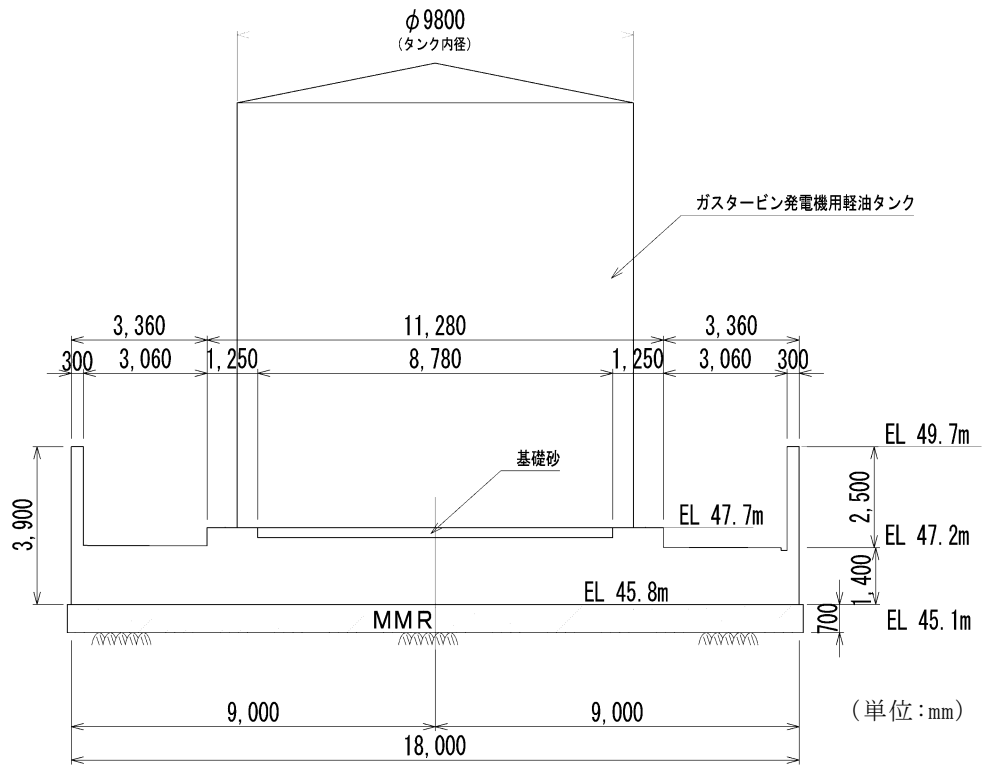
14-3 ガスタービン発電機用軽油タンク基礎 断面図
